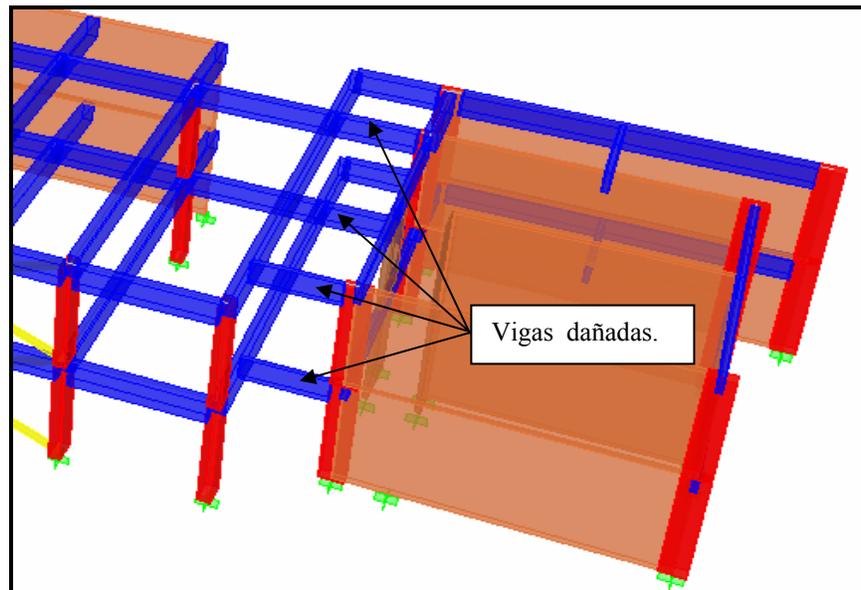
Vista de las 4 vigas afectadas por el terremoto
